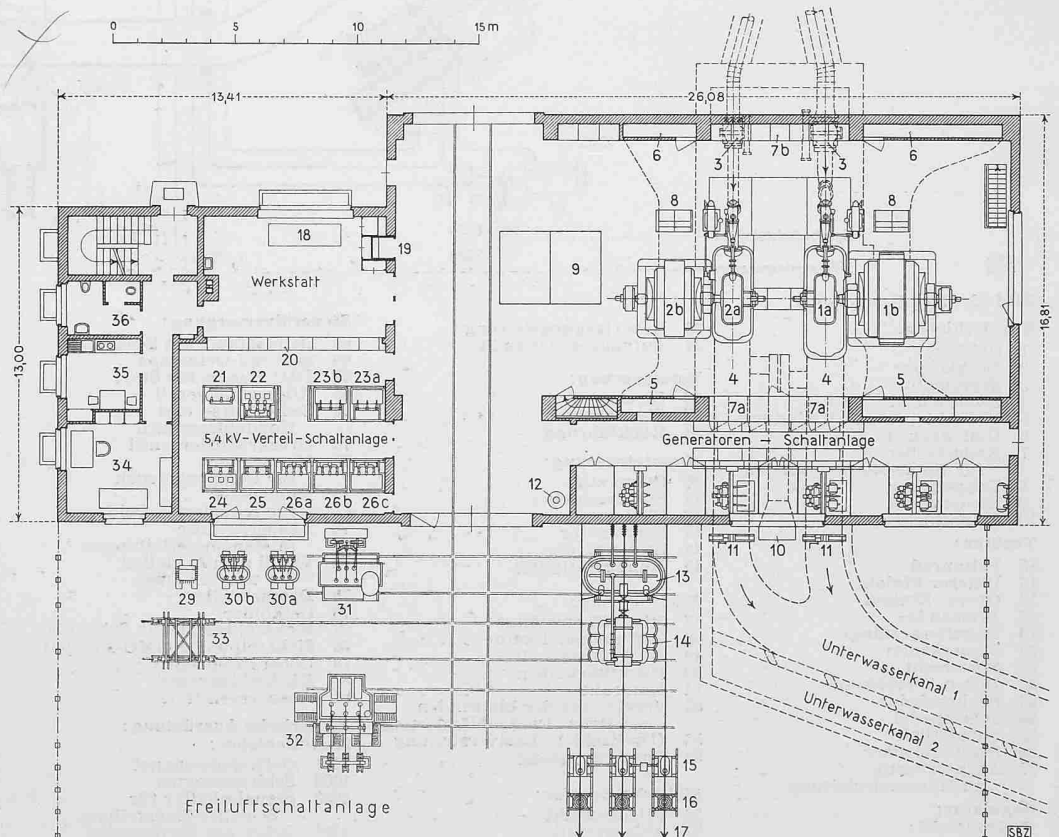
Grundriss des Maschinenhauses, Masstab 1:300
